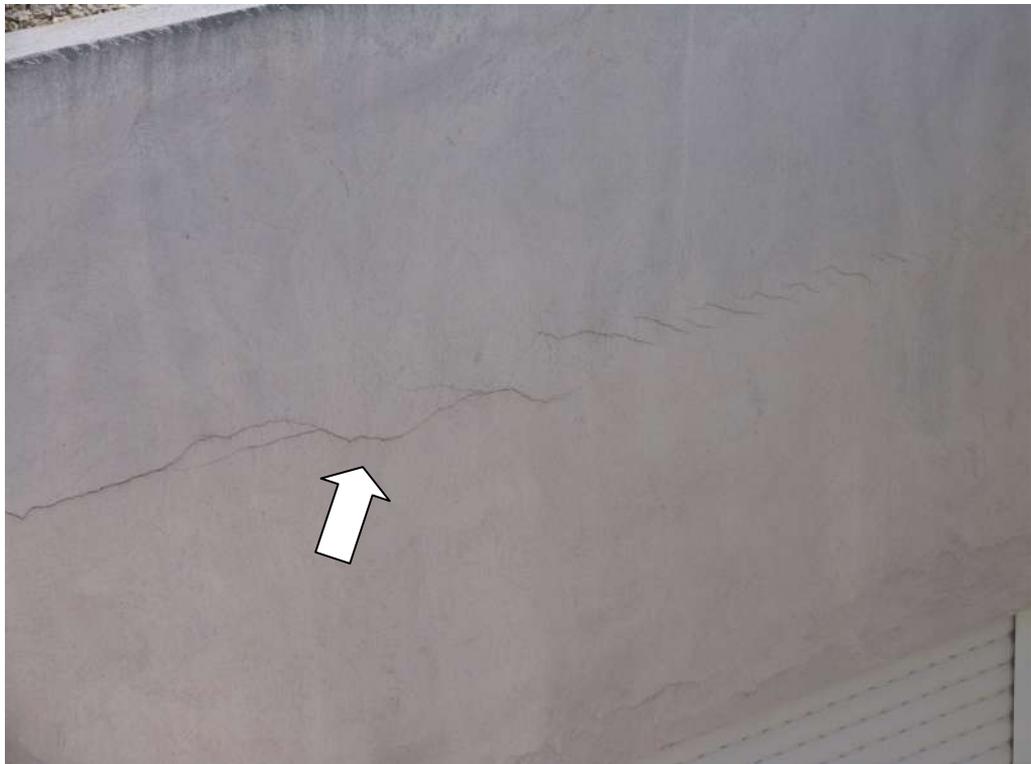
Otro caso de fisura en fachada patio de luces.
